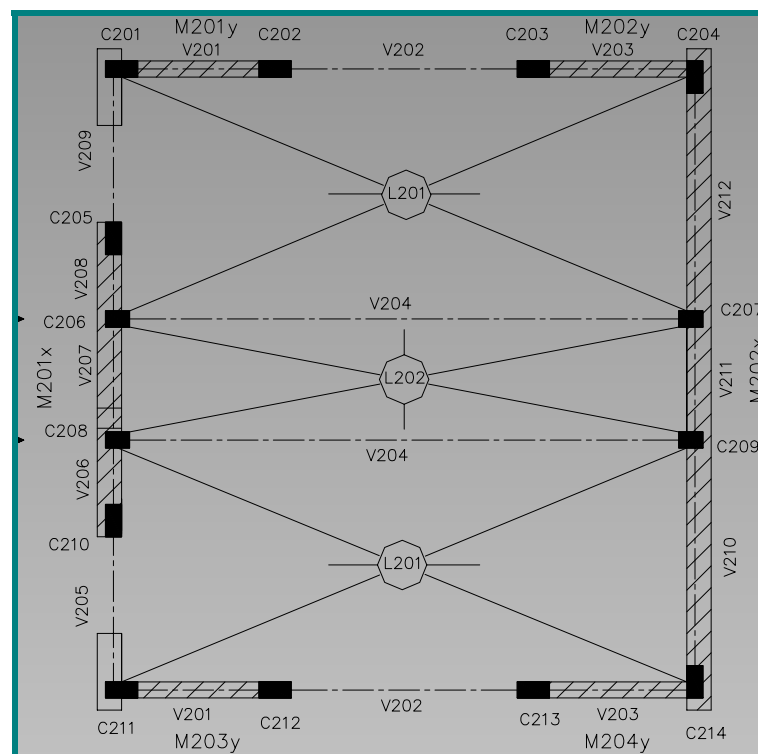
c: Planta de estructura del 2º nivel.
